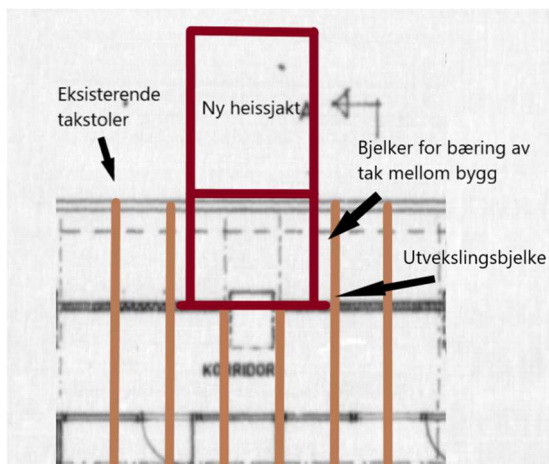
Snitt av takkonstruksjon og planutsnitt fra etterisolering i 1998.
